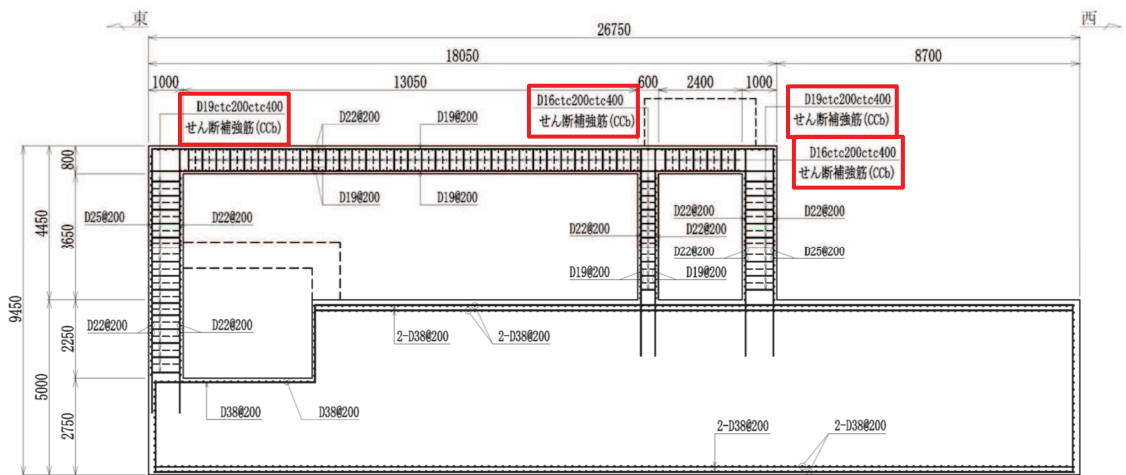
復水貯蔵タンク基礎 概略配筋図 (1-1 断面)
